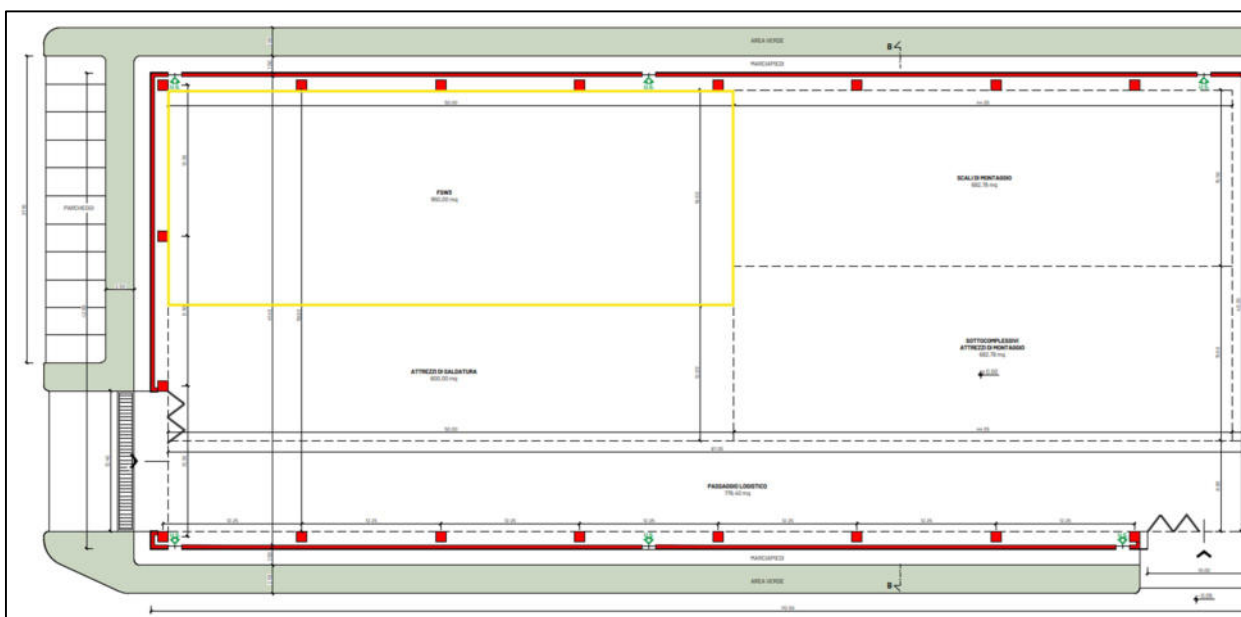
Planimetria dell'area lavorazioni con indicazione (perimetro giallo) dell'area destinata al FSW3
